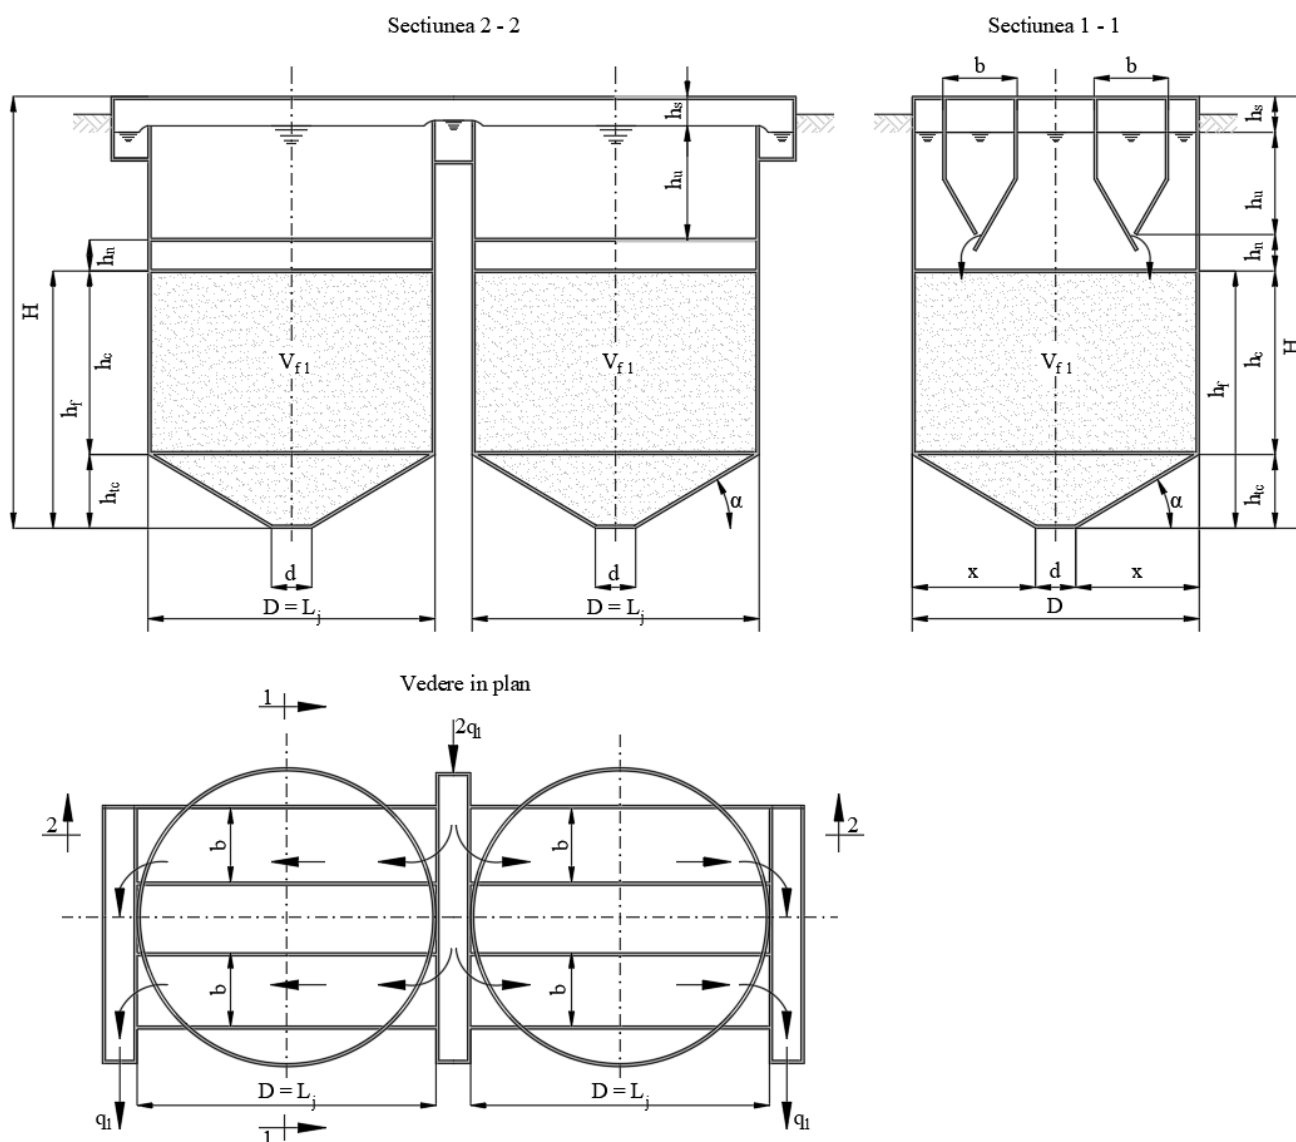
Decantare cu etaj. Dispoziție în plan și secțiuni caracteristice.
